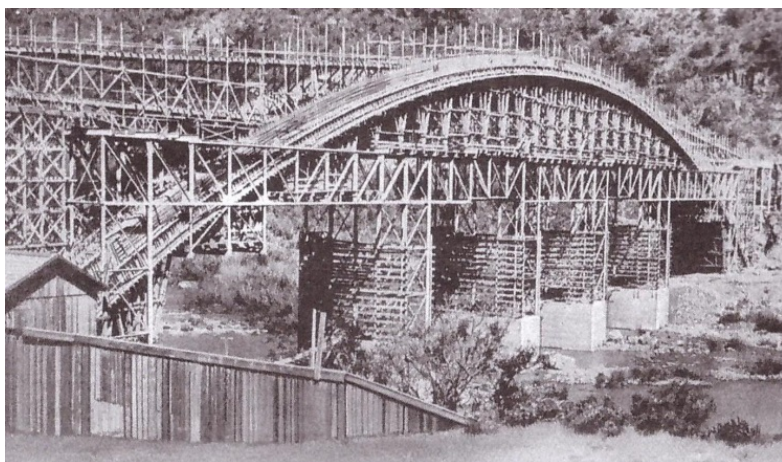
Obra da Ponte Ernesto Dornelles, 1950-52
